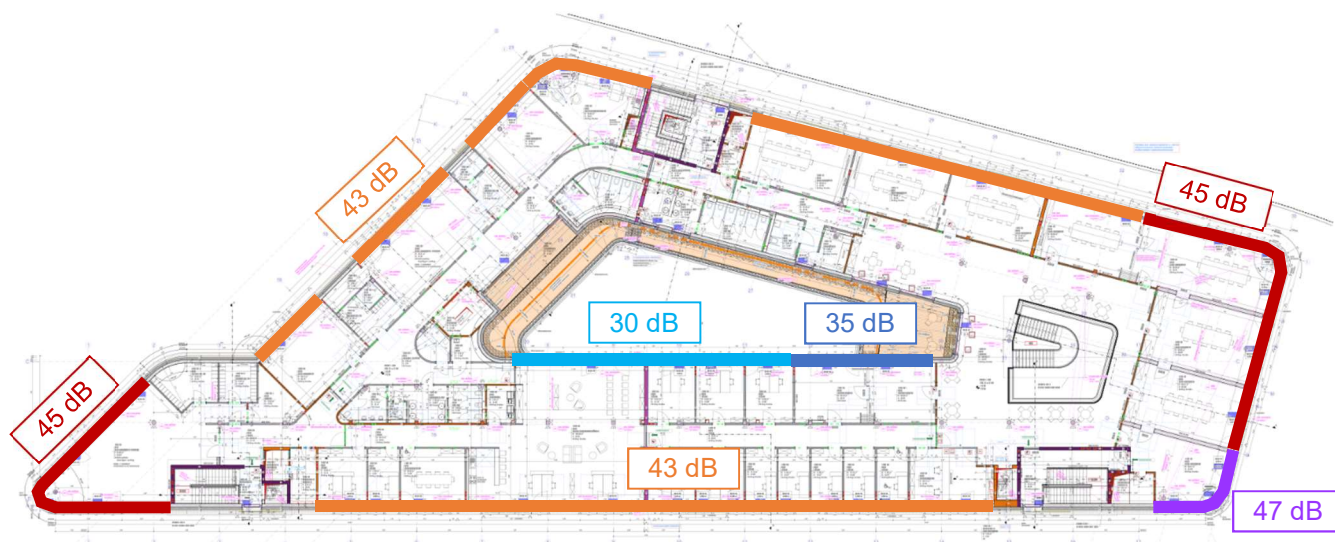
mögliche Fassadenabschnitte mit gleichen Fensterqualitäten von schutzbedürftigen Räumen im 1. Obergeschoss (Schalldämm-Maße angepasst)
